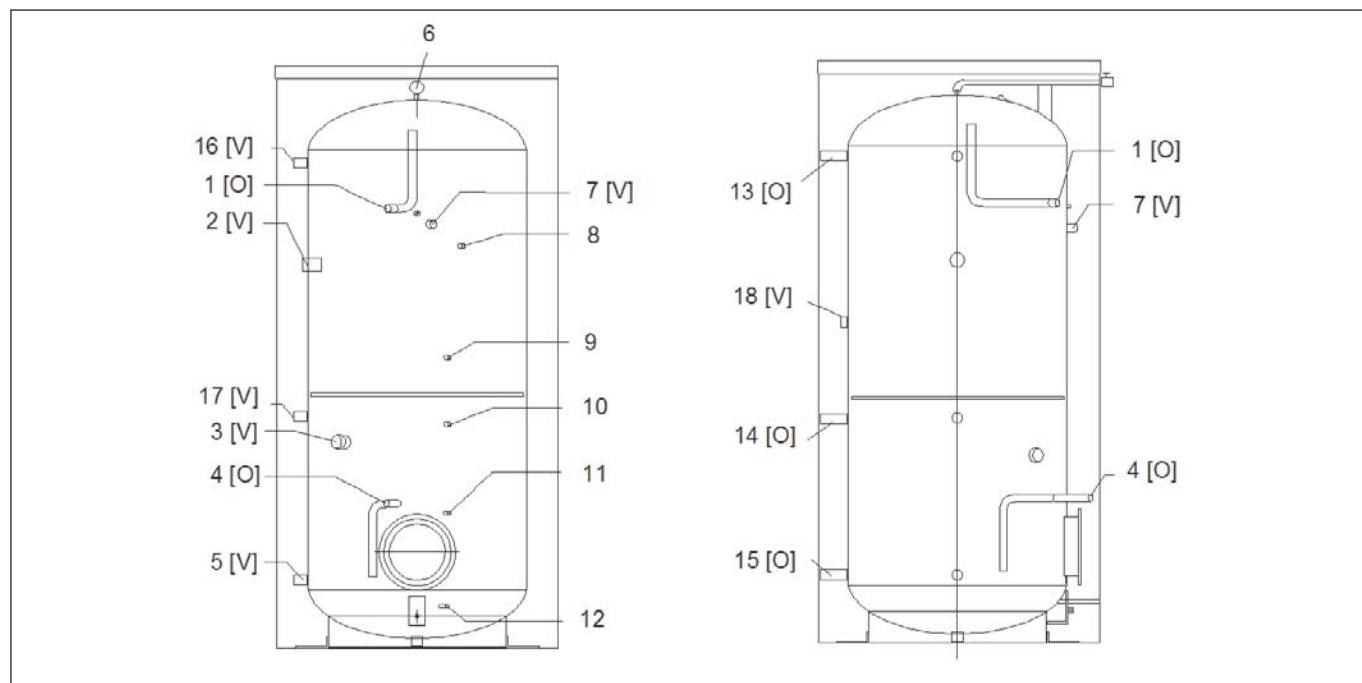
Размеры системного водонагревателя REHAU 825
